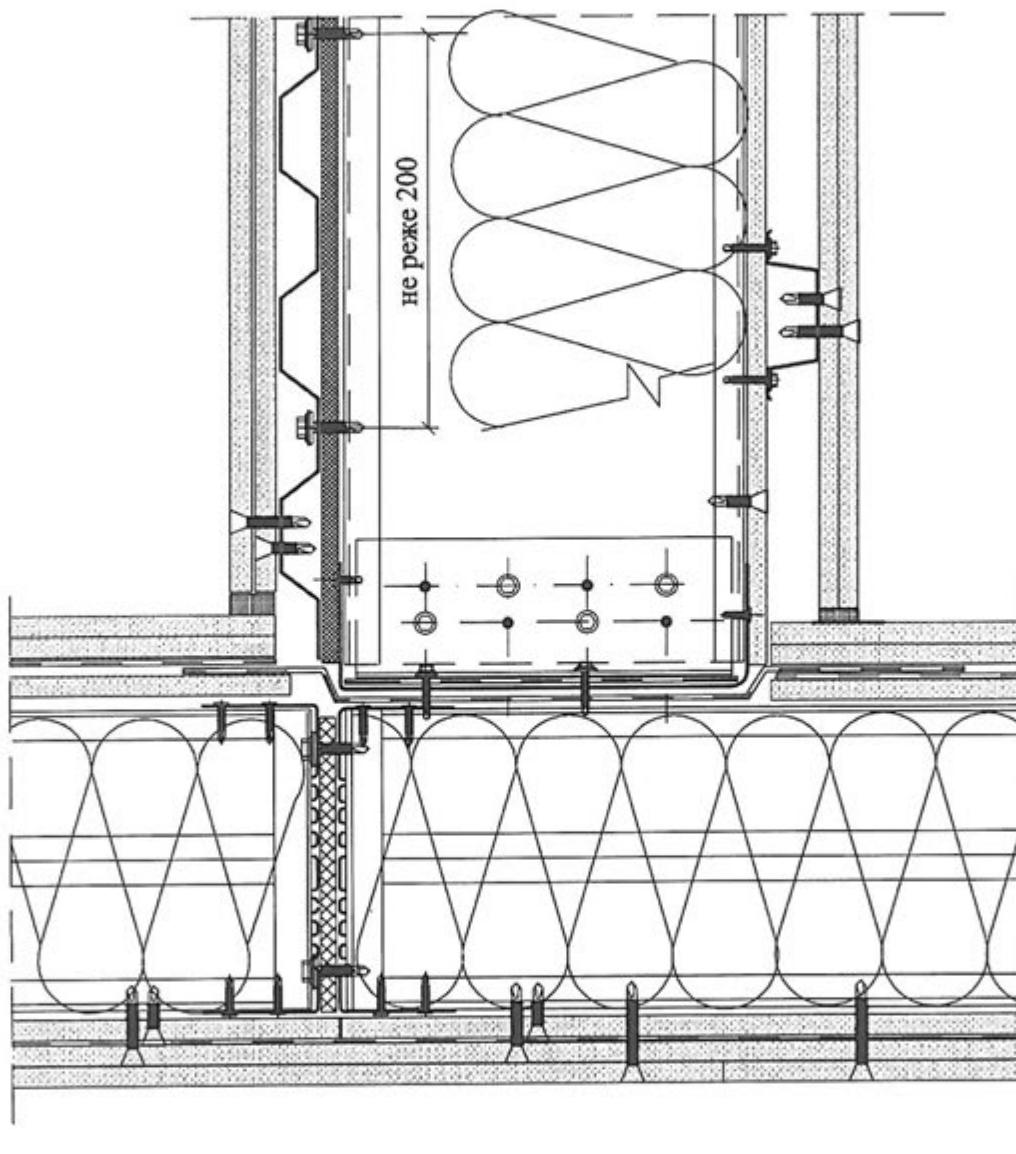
Узел крепления и примыкания конструкции чердачного перекрытия к торцовой наружной несущей стене.
